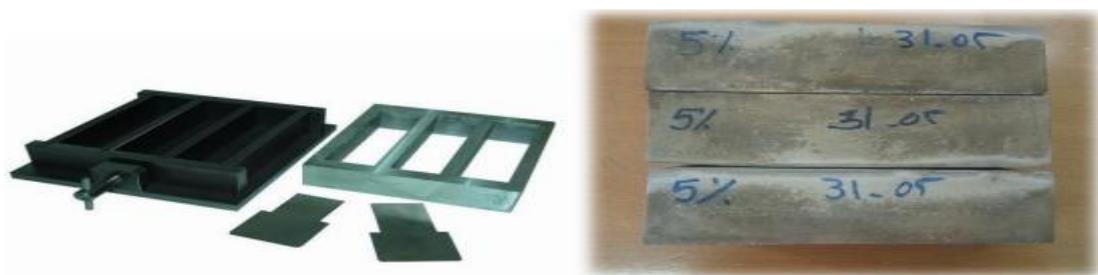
Moule utilisée pour l'élaboration d'éprouvette
